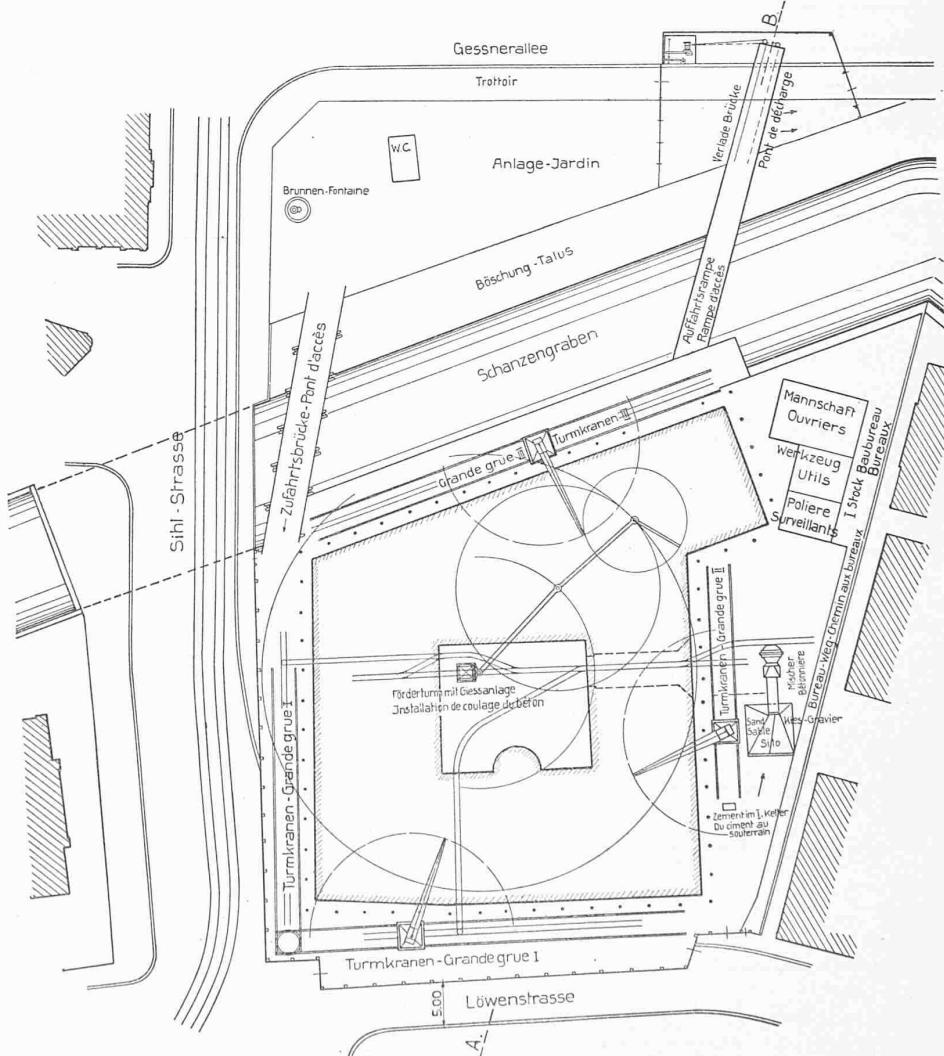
Lageplan der Bauinstallationen für den Neubau „zur Sihlporte“ in Zürich. — Maßstab rd. 1 : 800.
